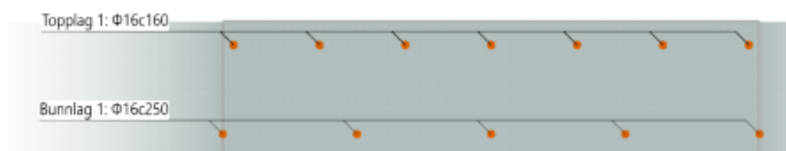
Oversikt over korteste akse på utvalgte dekker i plan 6
